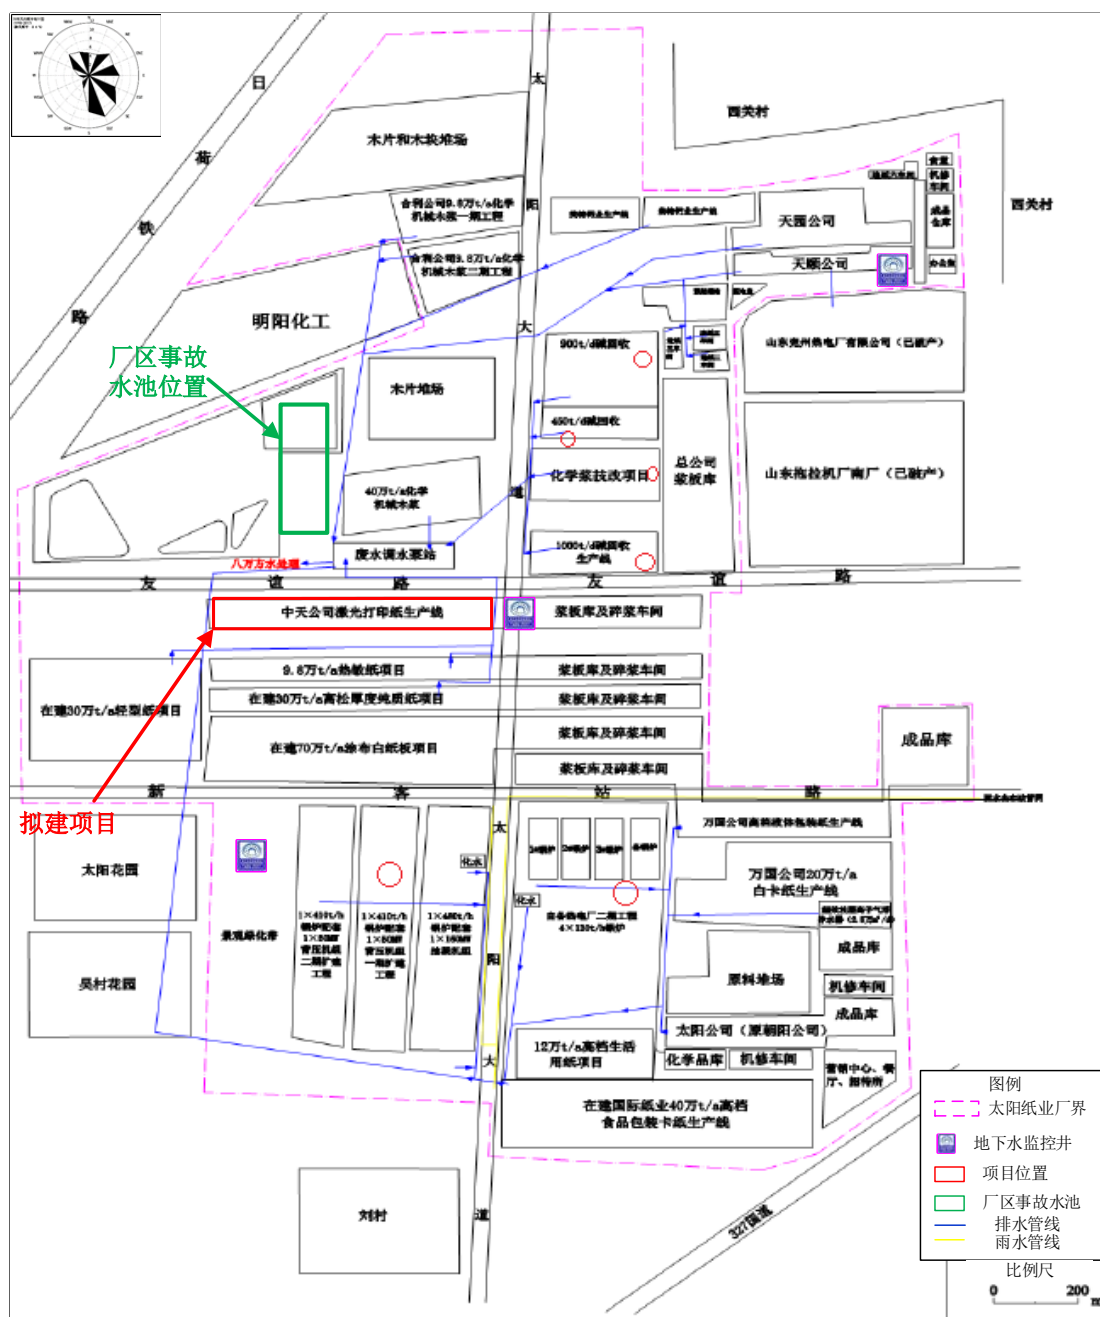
太阳纸业兖州工业园厂区平面布置图
